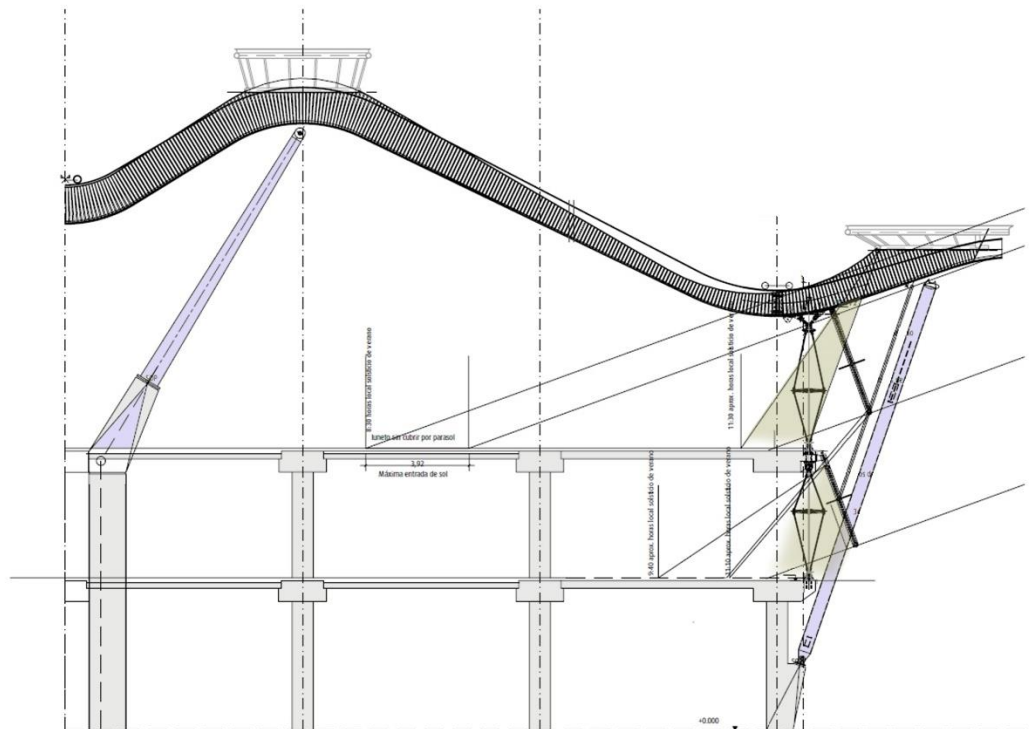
Esquema de Soleamiento Fachada Este. 11:40 am. Verano. Elaboración propia
